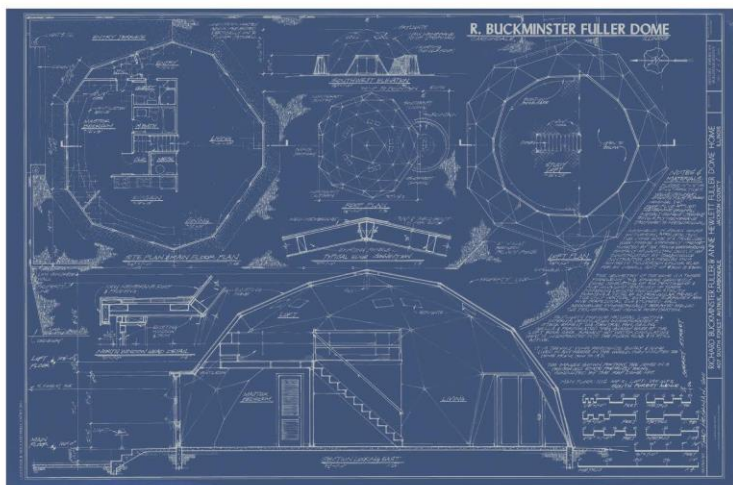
Plantas, alzados y secciones, Fuller's Home Dome. Dibujo de Heckman, T., 2011.
